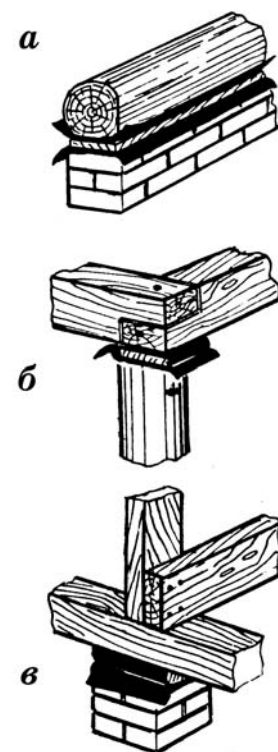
Варианты опираний конструкций стен на фундамент: а – нижняя обвязка из бревна, протесанного на два канта; б – соединение брусьев обвязки в полдерева; в – узел соединения нижней обвязки, стойки и лаги, уровень пола выше уровня обвязки.
